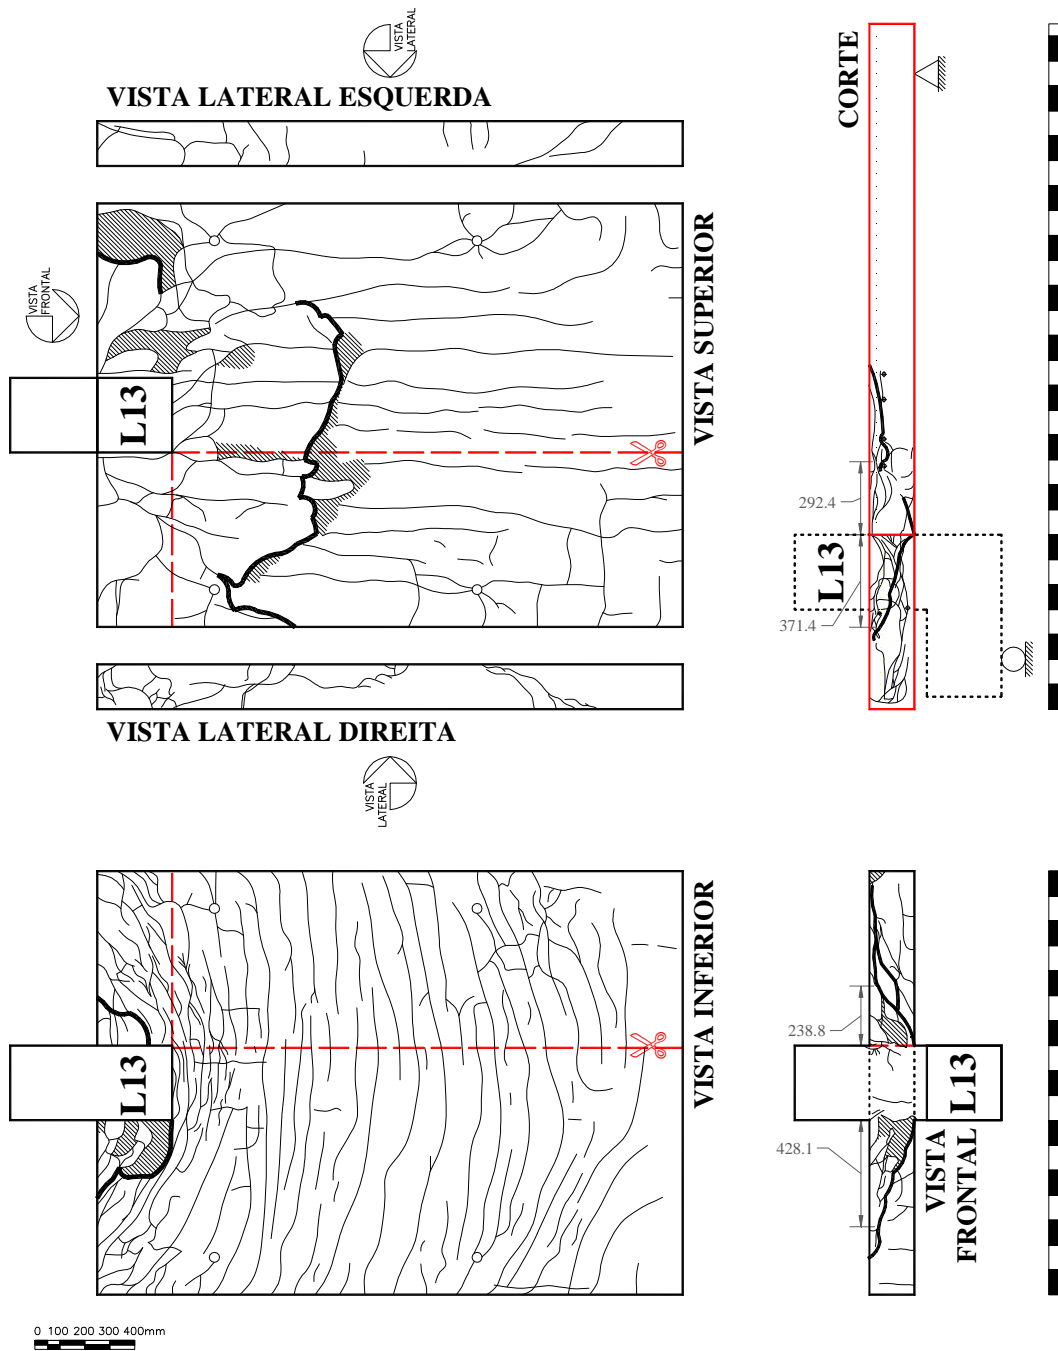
Padrão de fissuração da laje L13
